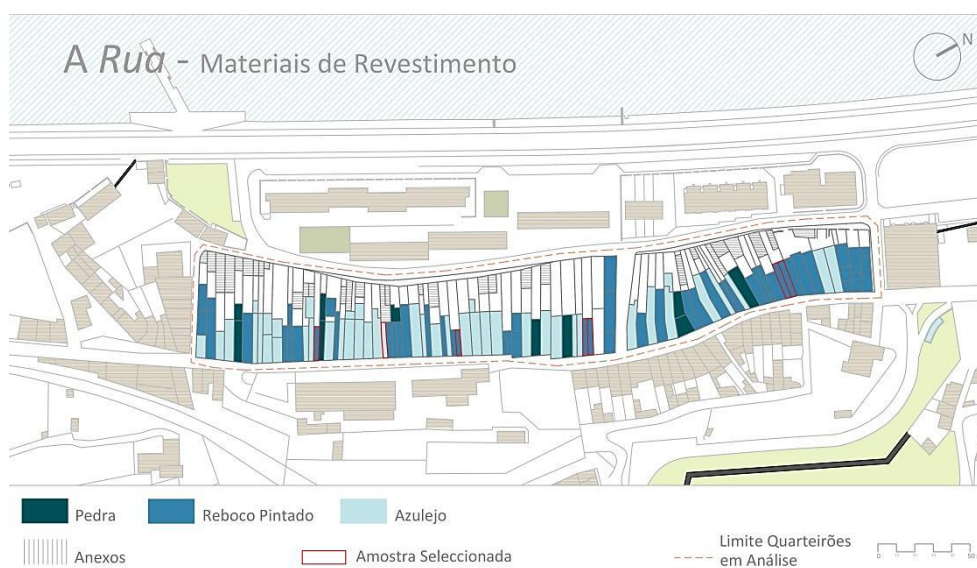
Tipos de Revestimento nas Fachadas Principais das Edificações da Rua
